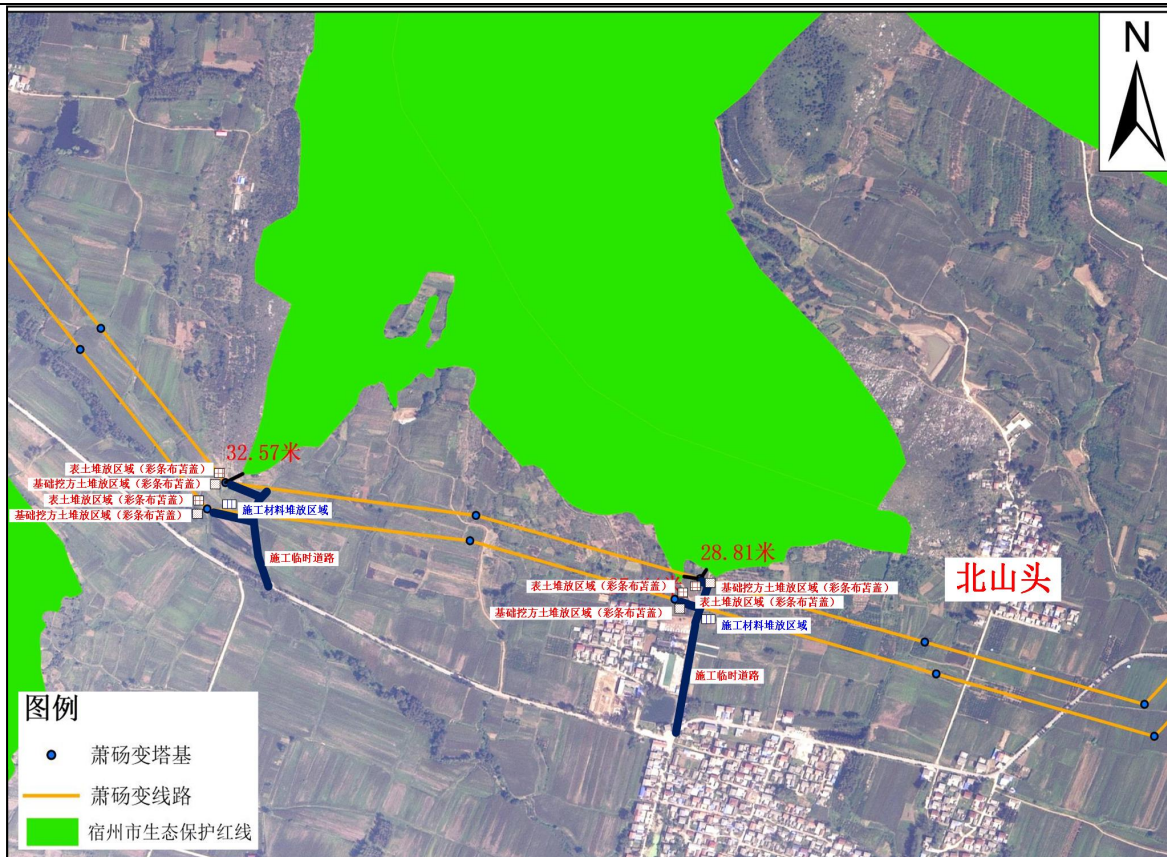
线路穿（跨）越生态保护红线段施工现场布置示意图（萧县北山头西侧）
